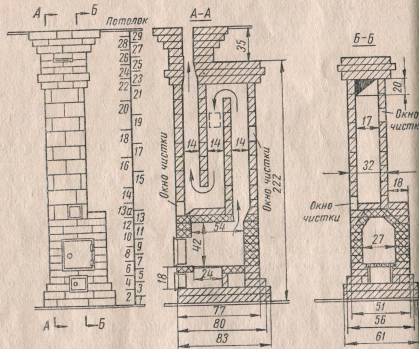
Лежанка трехоборотная конструкции К. Я. Буслаева.
